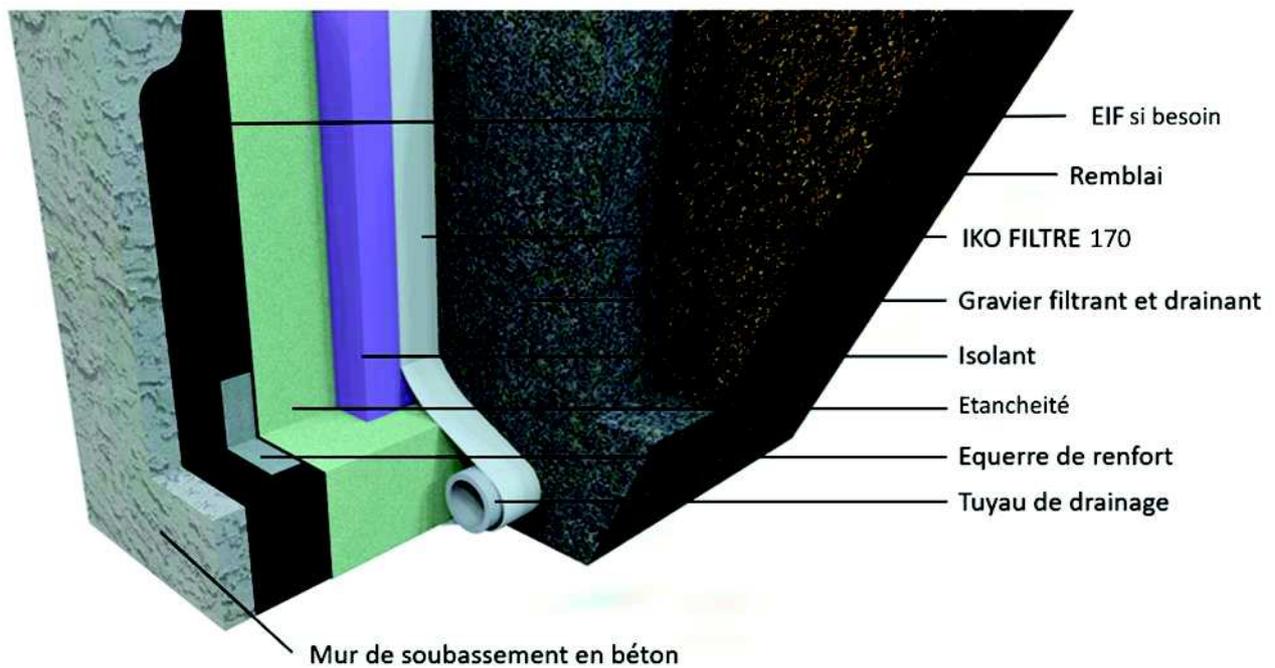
Paroi isolée (cas de l'isolant en appui sur la semelle)
